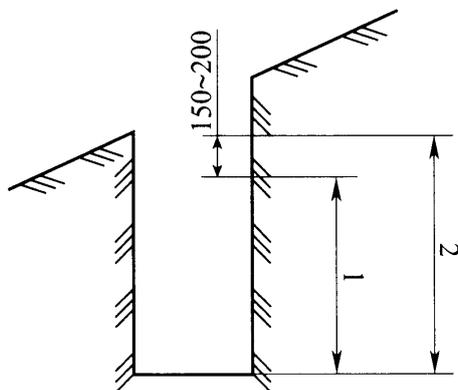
斜坡上的电杆洞洞深计量方法示意图
